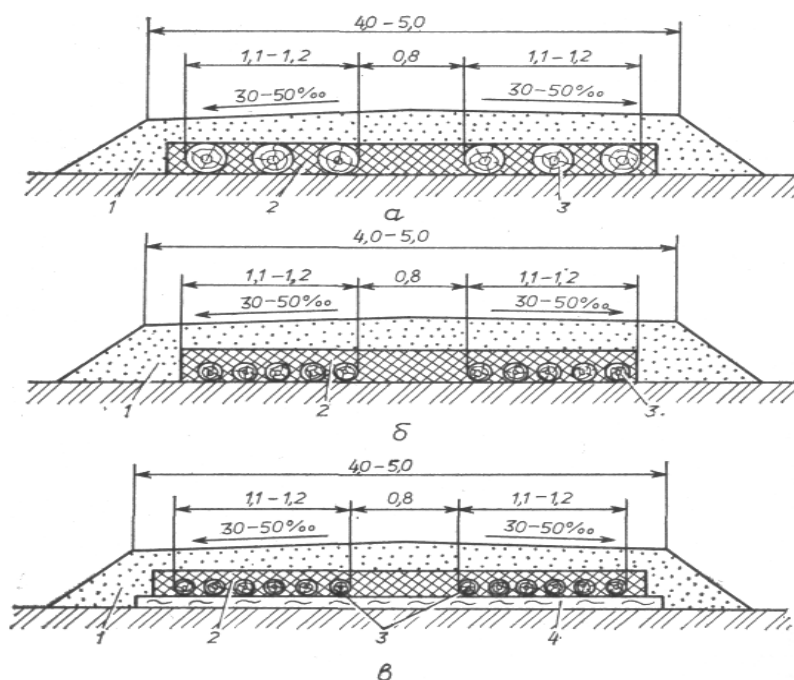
Конструкция уса на хворостяной выстилке с прослойкой грунта: а – на сырых участках с поперечным уклоном местности менее 1:25; б – на сыт участках с поперечным уклоном более 1:25; в – на неглубоких болотах, заполненных плотным торфом до дна; 1 – грунт; 2 – хворост; 3 – лежни; 4 – поперечный настил.
